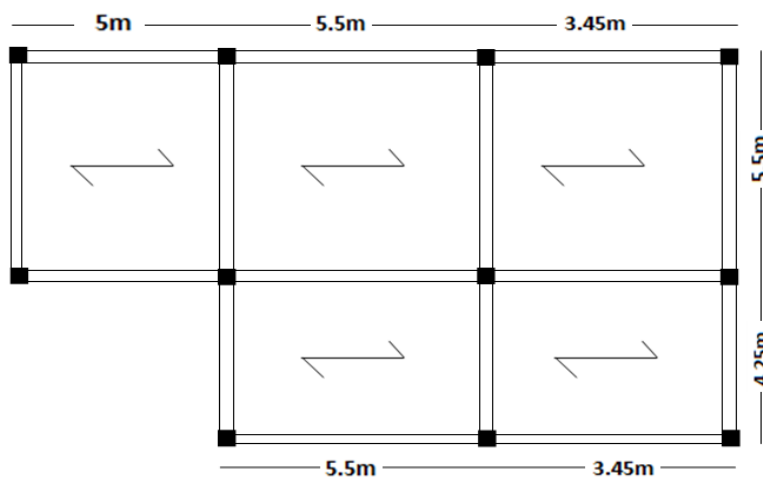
Schéma de disposition des poutrelles du plancher terrasse inaccessible.
